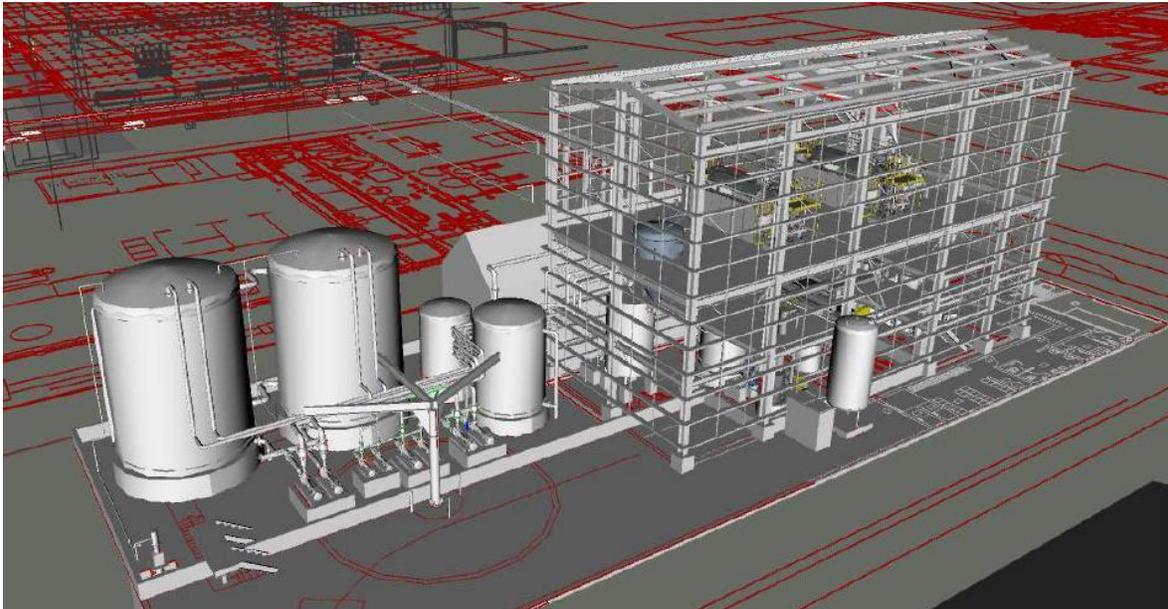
Disposición General Planta Tratamiento PRRC – Vista Tridimensional.
